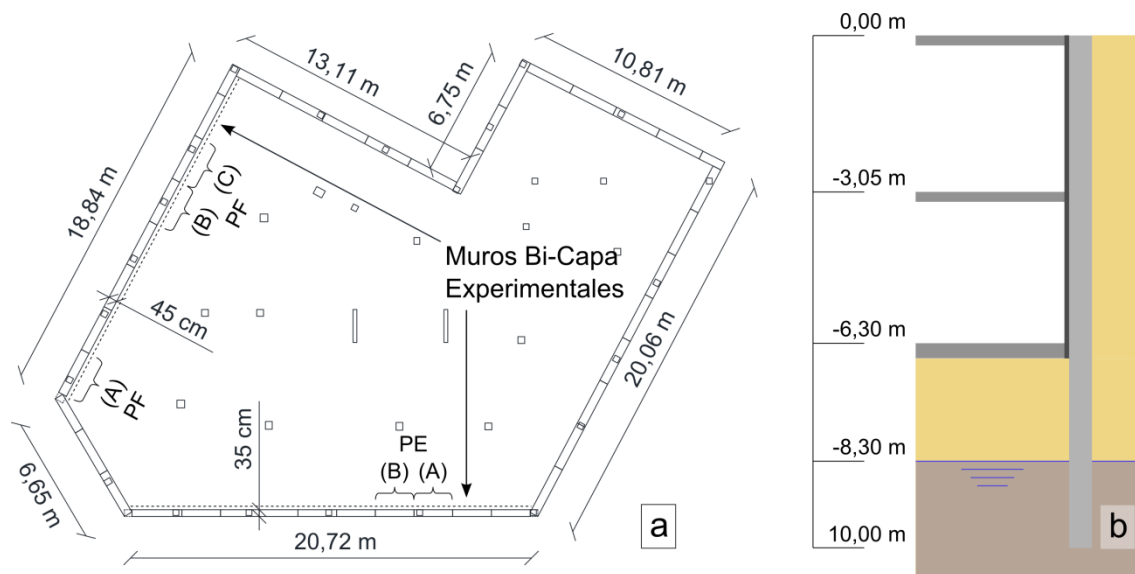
Detalle de las pantallas: a) Plano del sitio de obra; b) corte lateral
